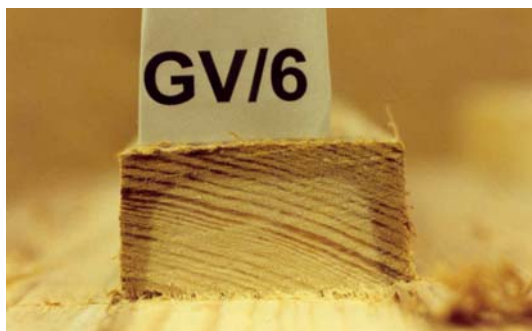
Anschnitt einer aufgestellten Lamelle mit Geopolymerbeton
